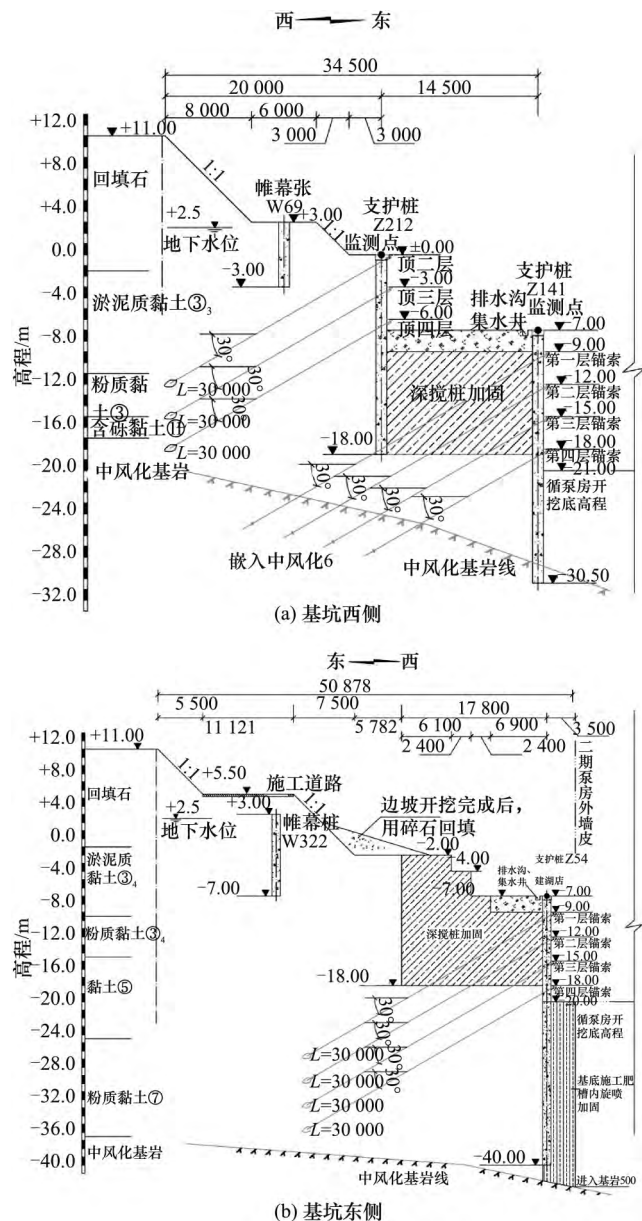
基坑支护典型断面(高程单位: m, 尺寸单位: mm)
